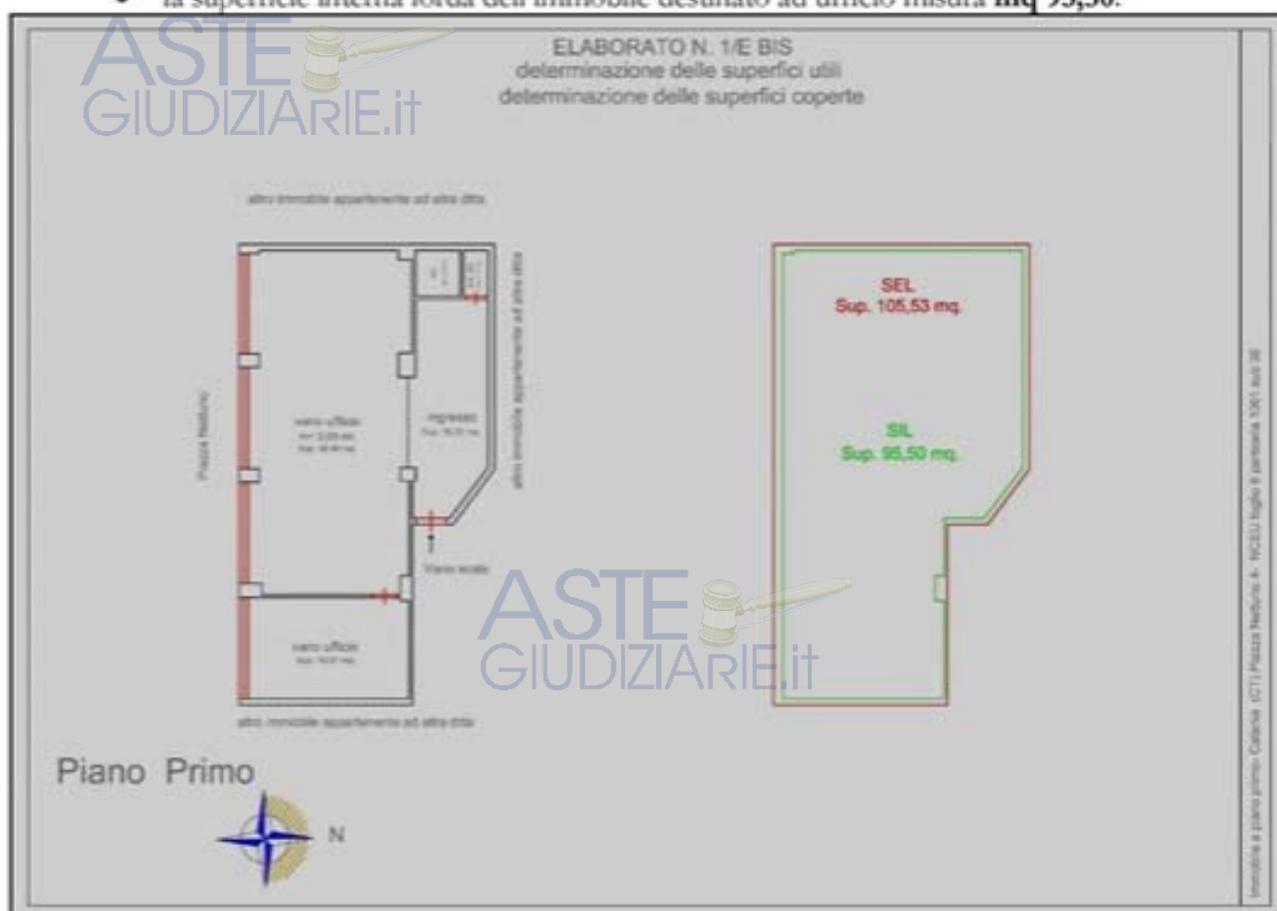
Visualizzazione della planimetria dell'immobile con indicazione delle superfici utili interne a piano primo
